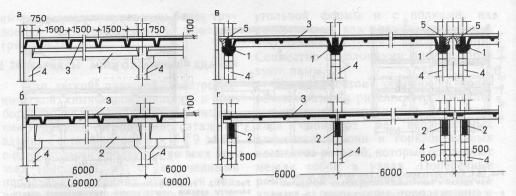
Сборные железобетонные перекрытия a — поперечный разрез перекрытия с ригелем с полками 1; δ — то же, с ригелем прямоугольной формы 2; s — продольный разрез перекрытия с ригелем 1, z — то же, с ригелем 2; s — ребристый настил перекрытия; s — колонна; s — монолитный бетон
